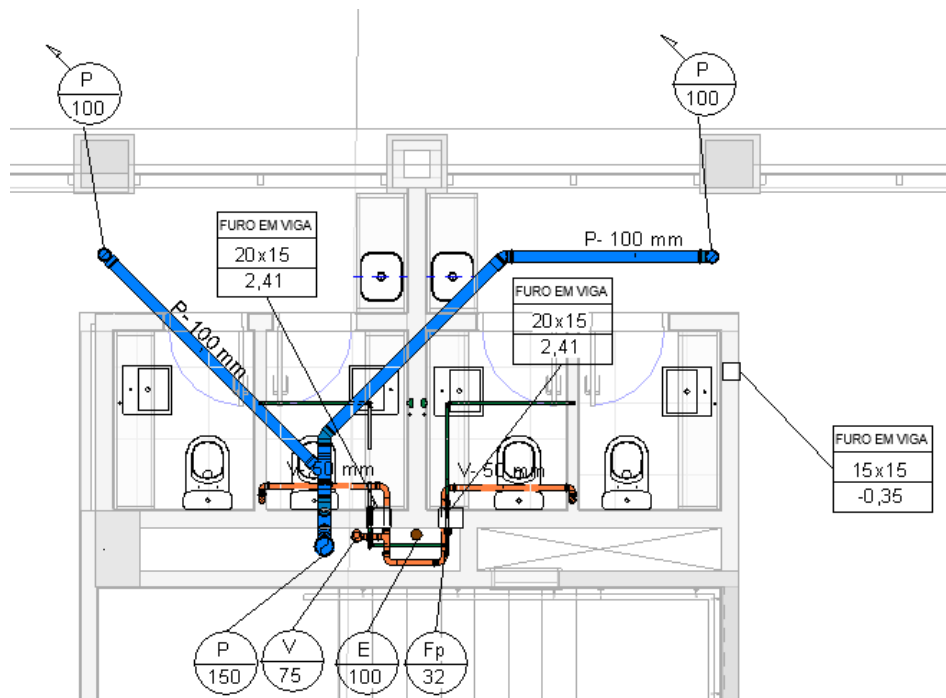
Planta baixa do Pavimento Ático – destaque grelha drenagem.
